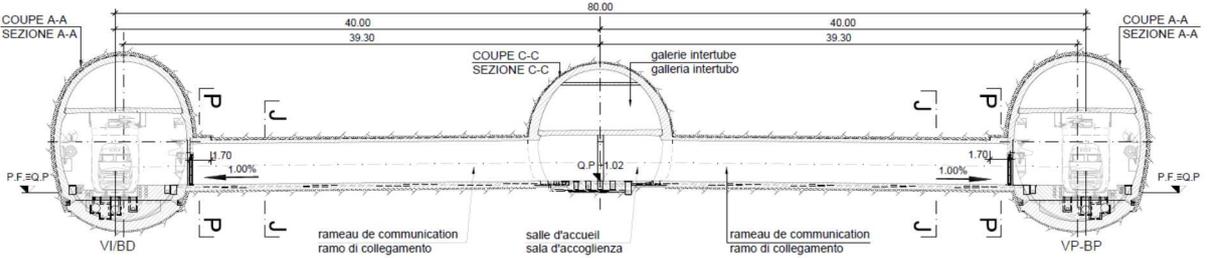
Ramo di collegamento: sezione trasversale [28]
